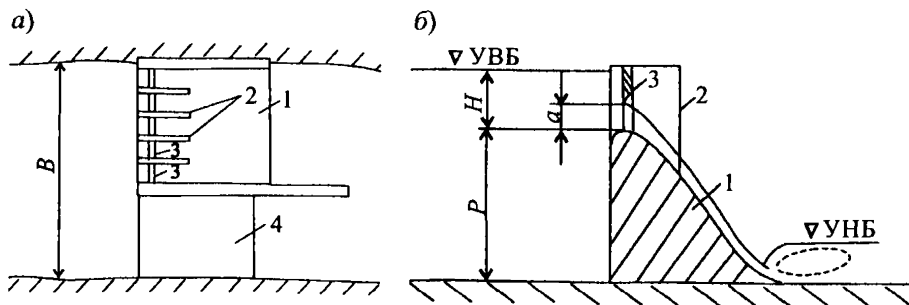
План гидроузла (а) и разрез по водосливной плотине (б):
